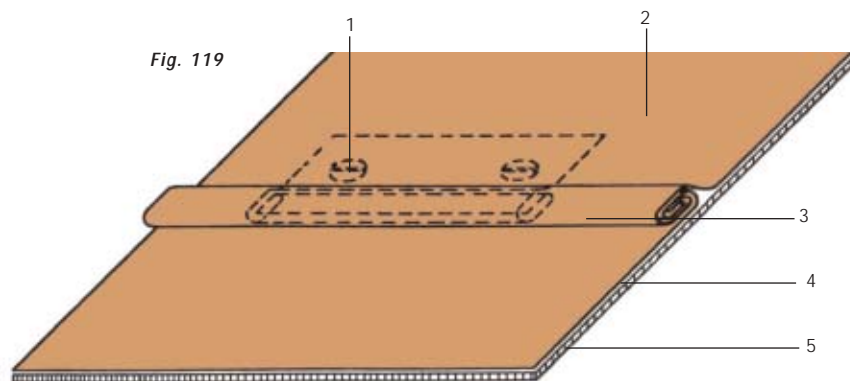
Detalhe da junta das chapas / bandas horizontais
